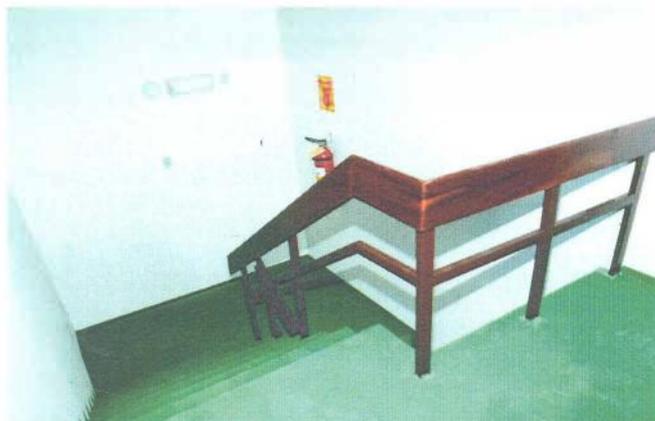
Jaçanã. Vista interna do patamar da escada.
